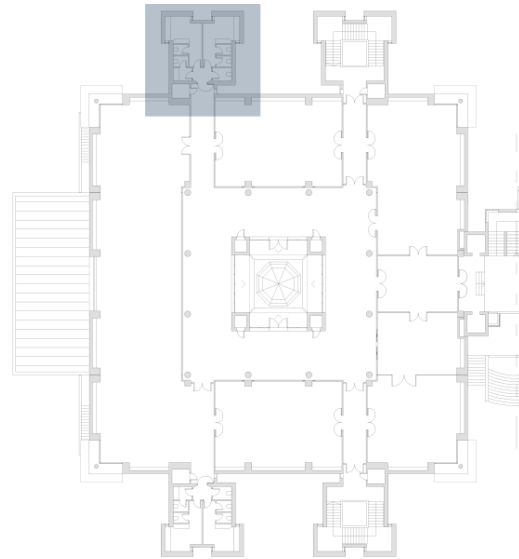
Planta 3ª Edificio Académico (Elaboración propia)
